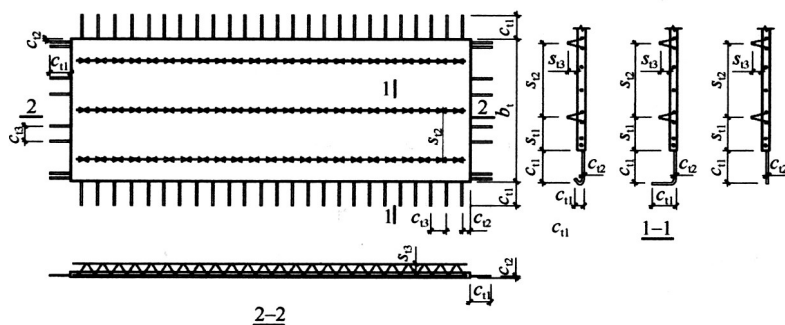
预制平板预留外伸钢筋尺寸允许偏差示意
